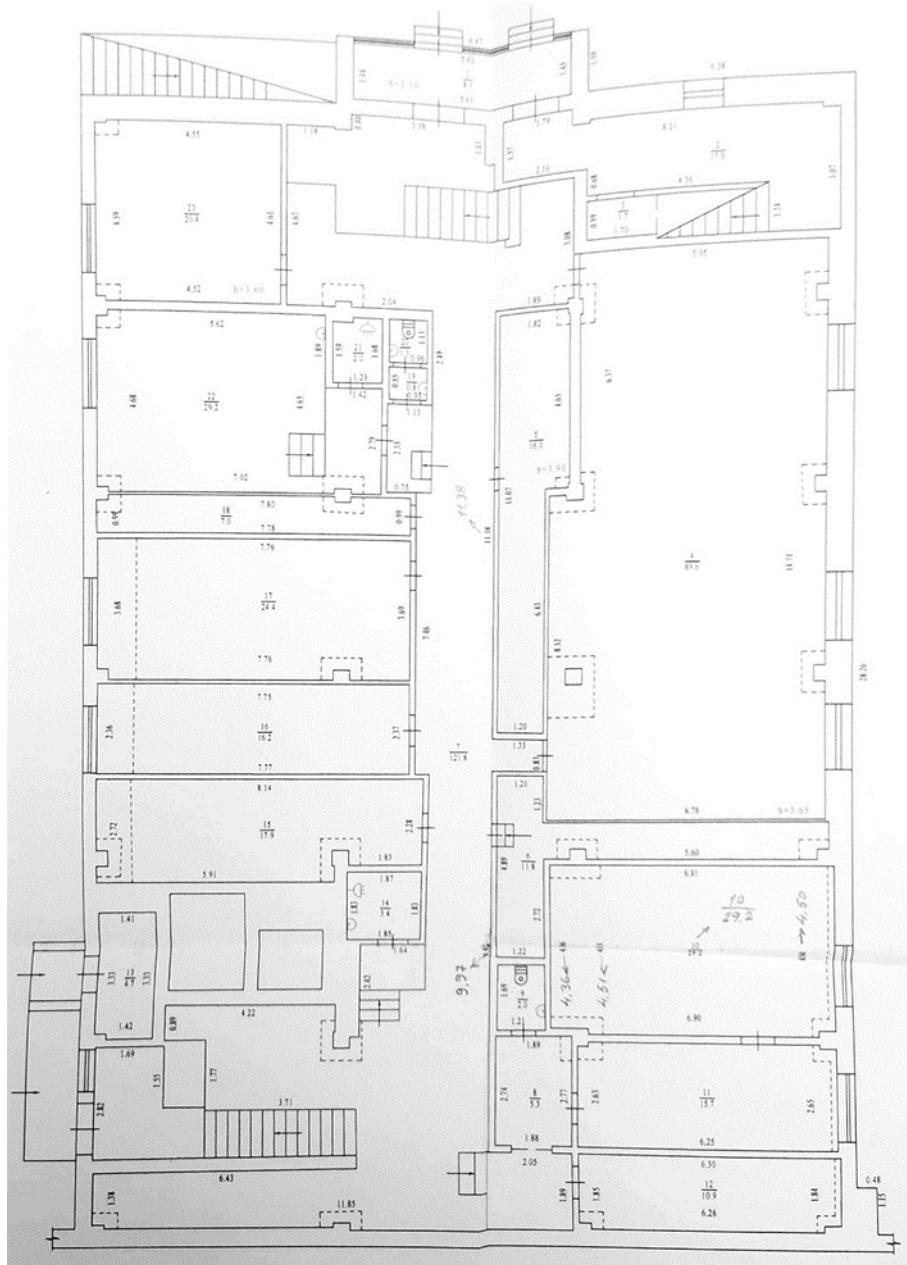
Фрагмент плану цокольного поверху будівлі гуртожитку літ. «В-9».
